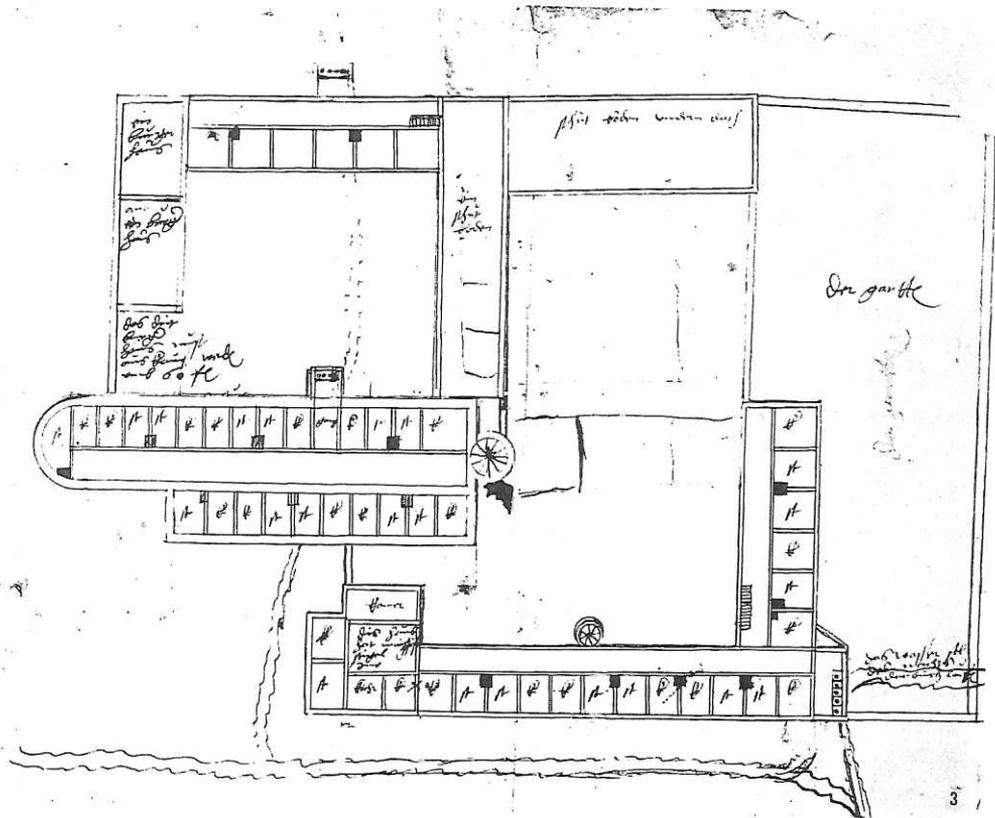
(3) 2. Stockwerk (Kirche) bzw. Dachgeschoß (Kollegiengebäude und Wirtschaftsgebäude)
